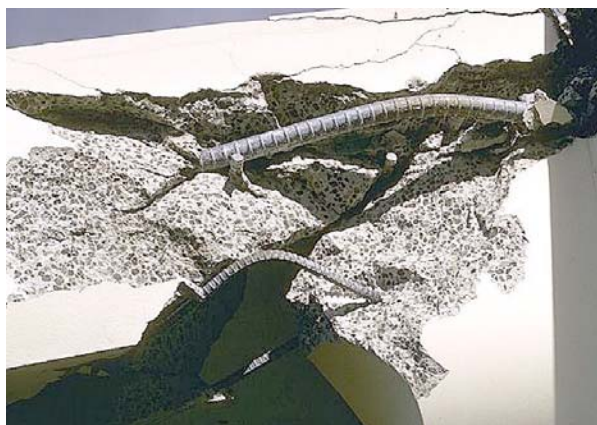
Colapso estructural de una unión por cargas sísmicas
